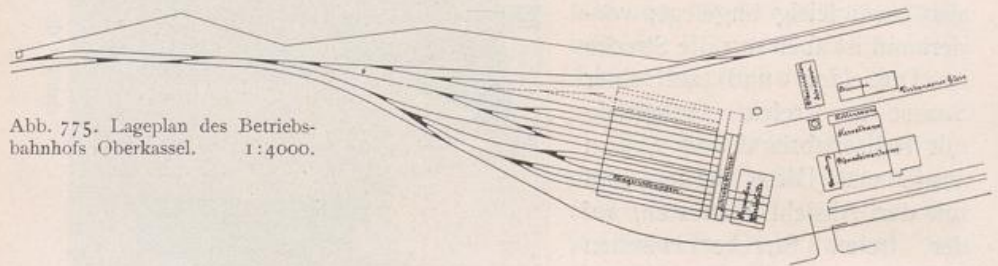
Lageplan des Betriebsbahnhofes Oberkassel. 1:4000.
